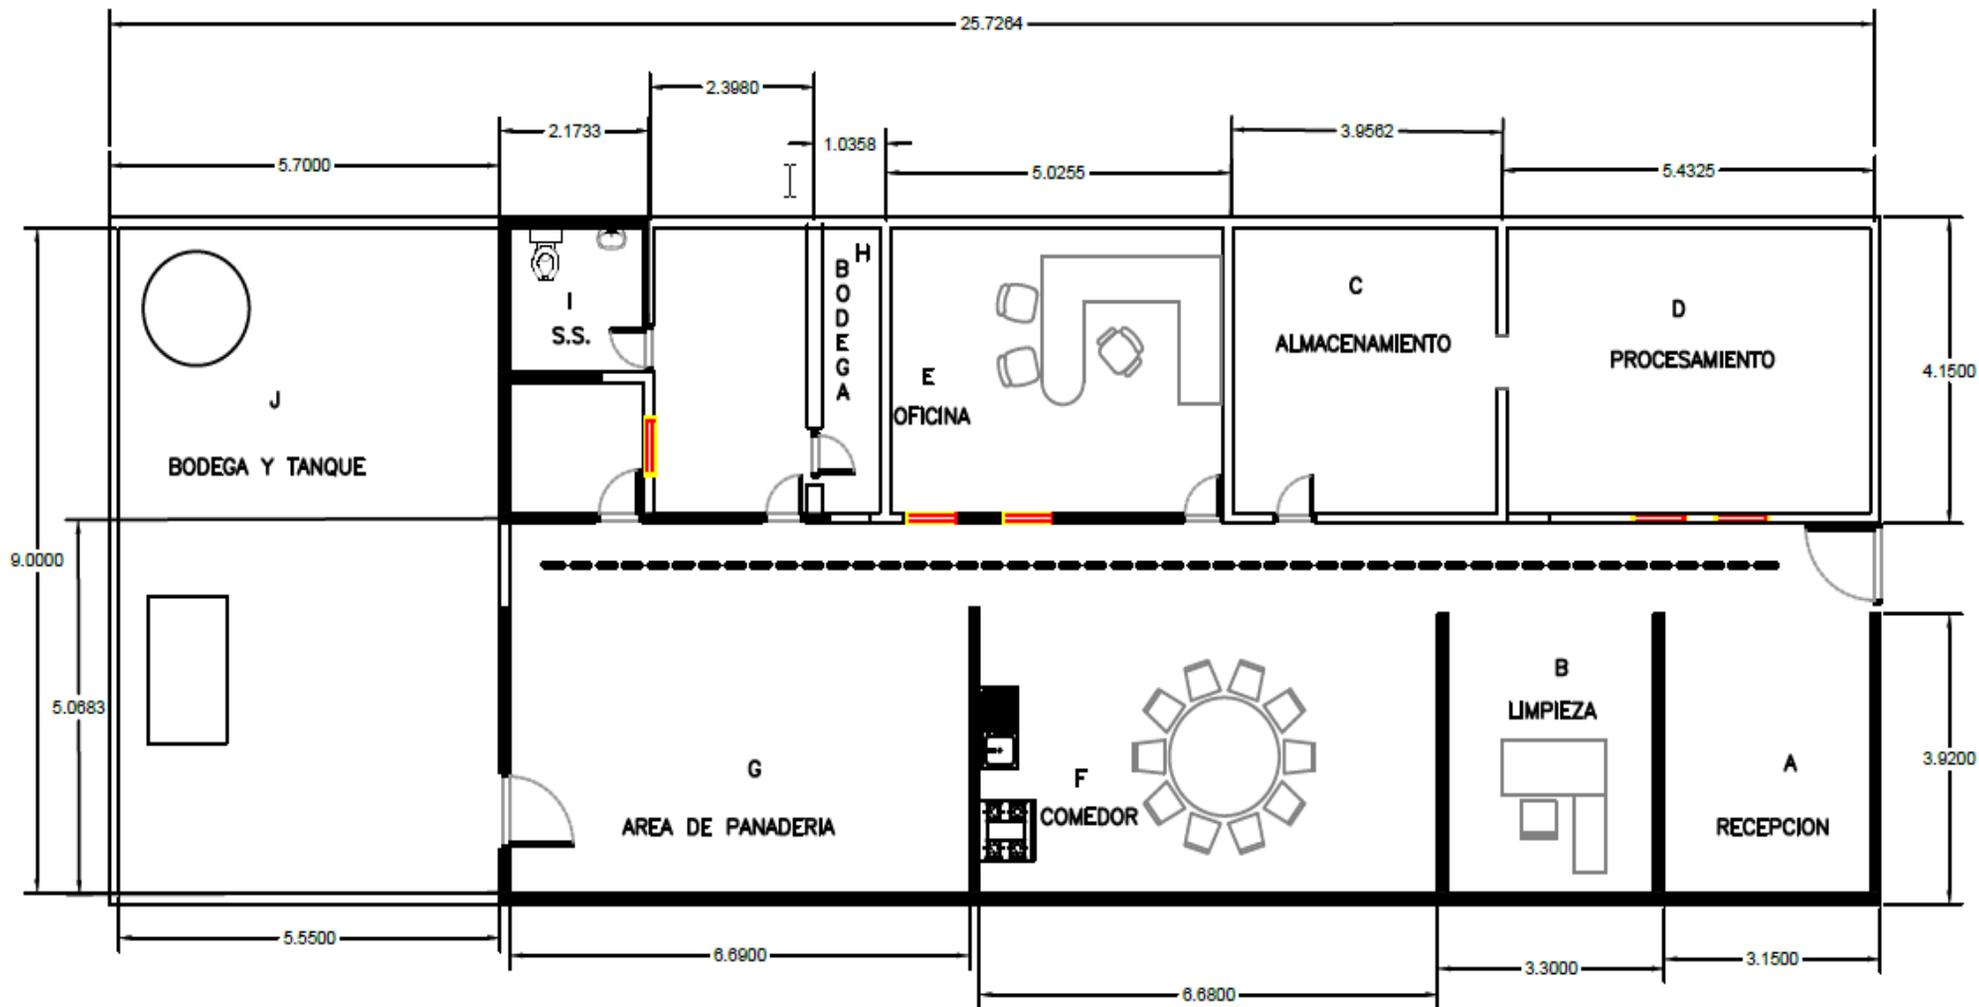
Diseño y distribución actual de la planta NUTRAVIDA (Esc. 1:100)
